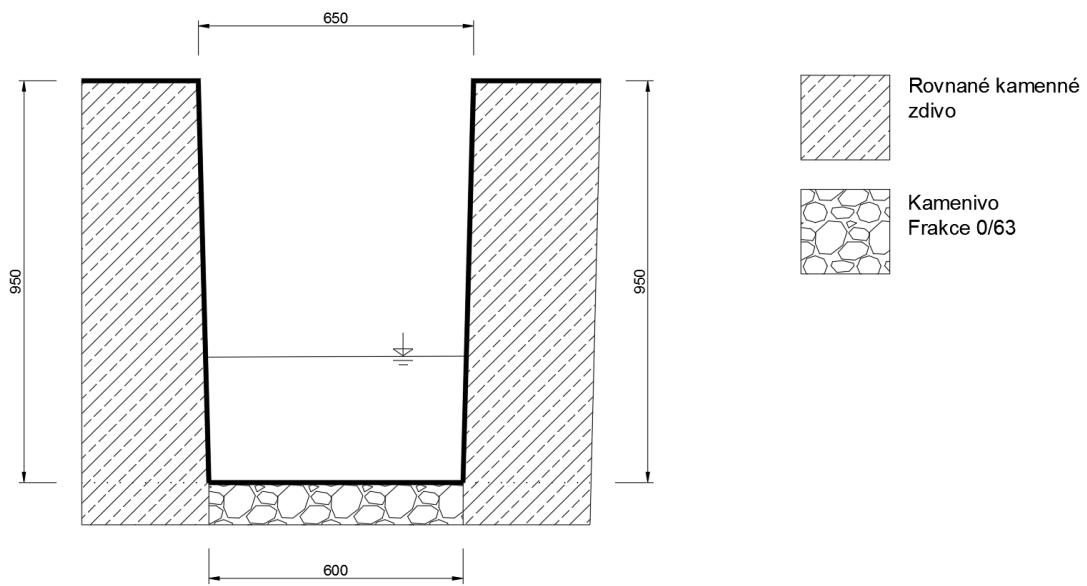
Schéma příčného profilu č. 4 - bezejmenný tok
